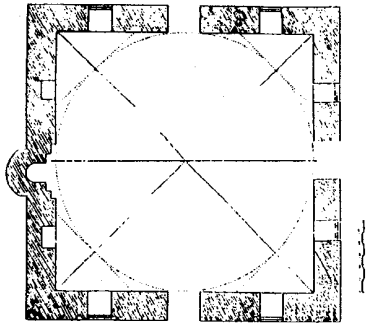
مكرر) مسقط أفقى لزاوية الأحمدية
